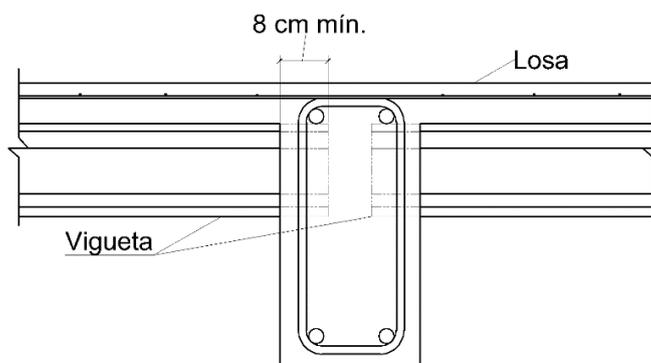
Colocación de viguetas pretensadas de entrecimso.
